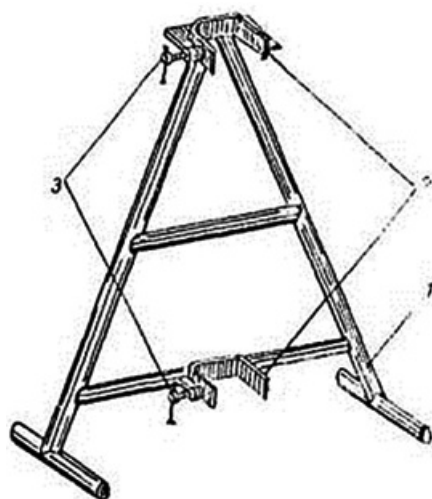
Стойка для временного крепления гипсобетонных перегородок
